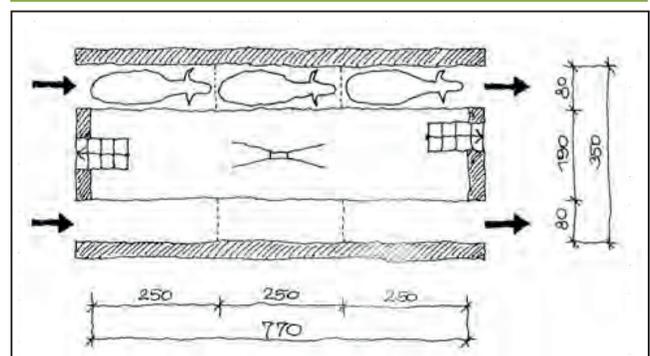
Grundriss Durchtreibmelkstand.
